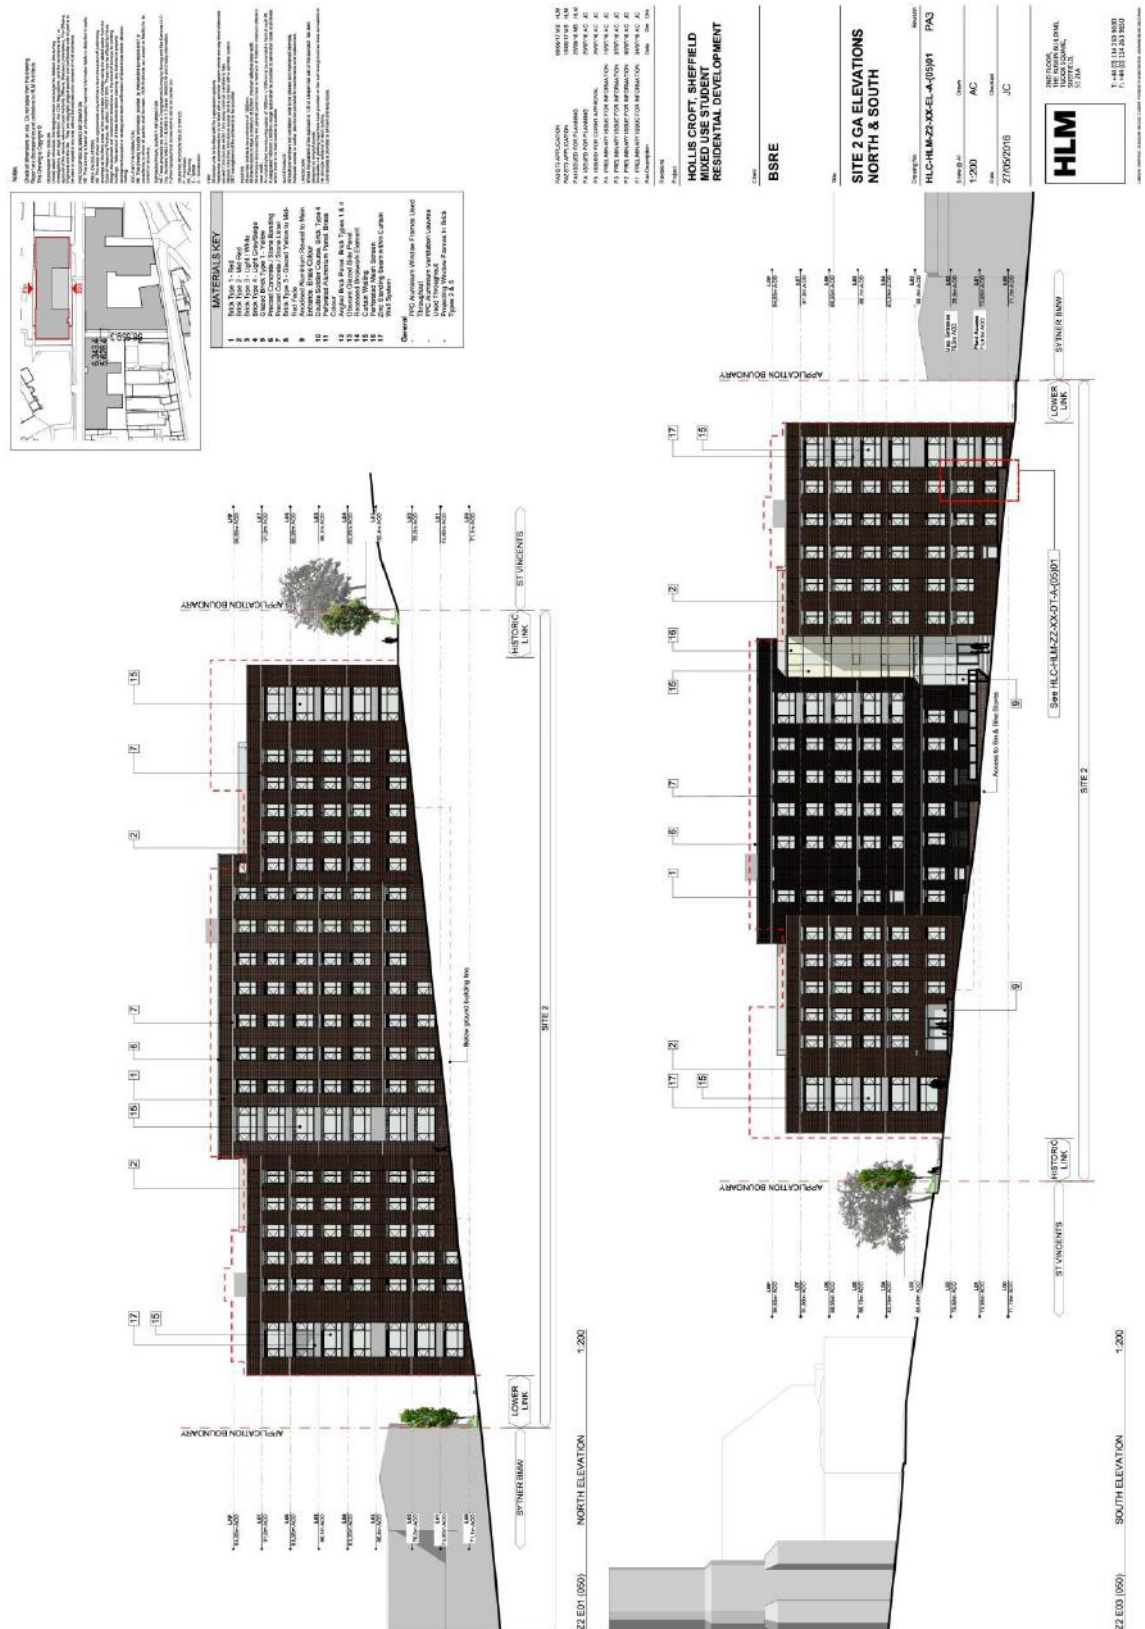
Exemplo de planta de arquitetura apresentada para obtenção da Permissão do Planejamento. Fonte: Site de Sheffield City Council.
